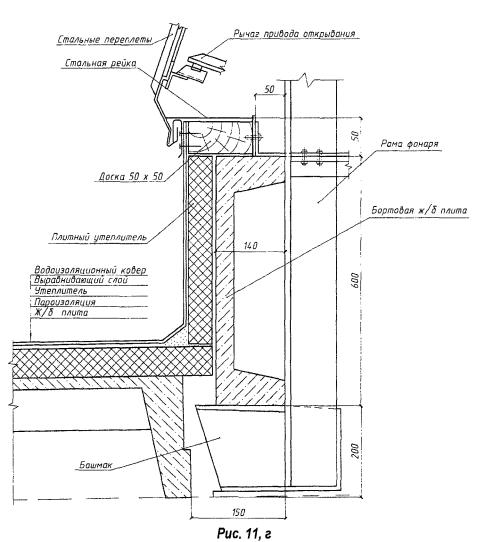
, в. Ограждающие конструкции прямоугольного фонаря на сборных железобетонных панелях отапливаемого здания
